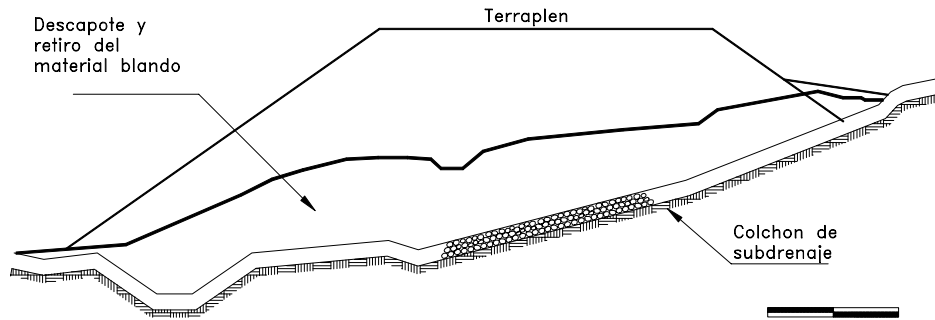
Diagrama de un colchón de drenaje colocado debajo de un terraplén.
